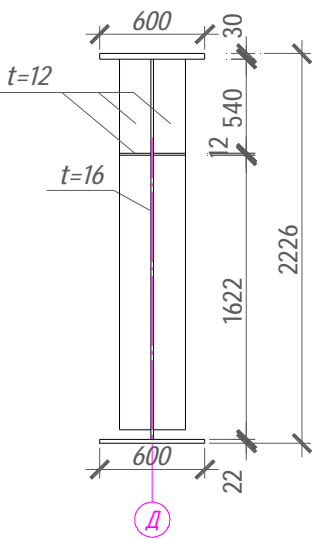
Поперечное сечение подкрановой балки по осям «Д» и «Е» для кранов пролета «Д–Е» на отметке 24 м.
